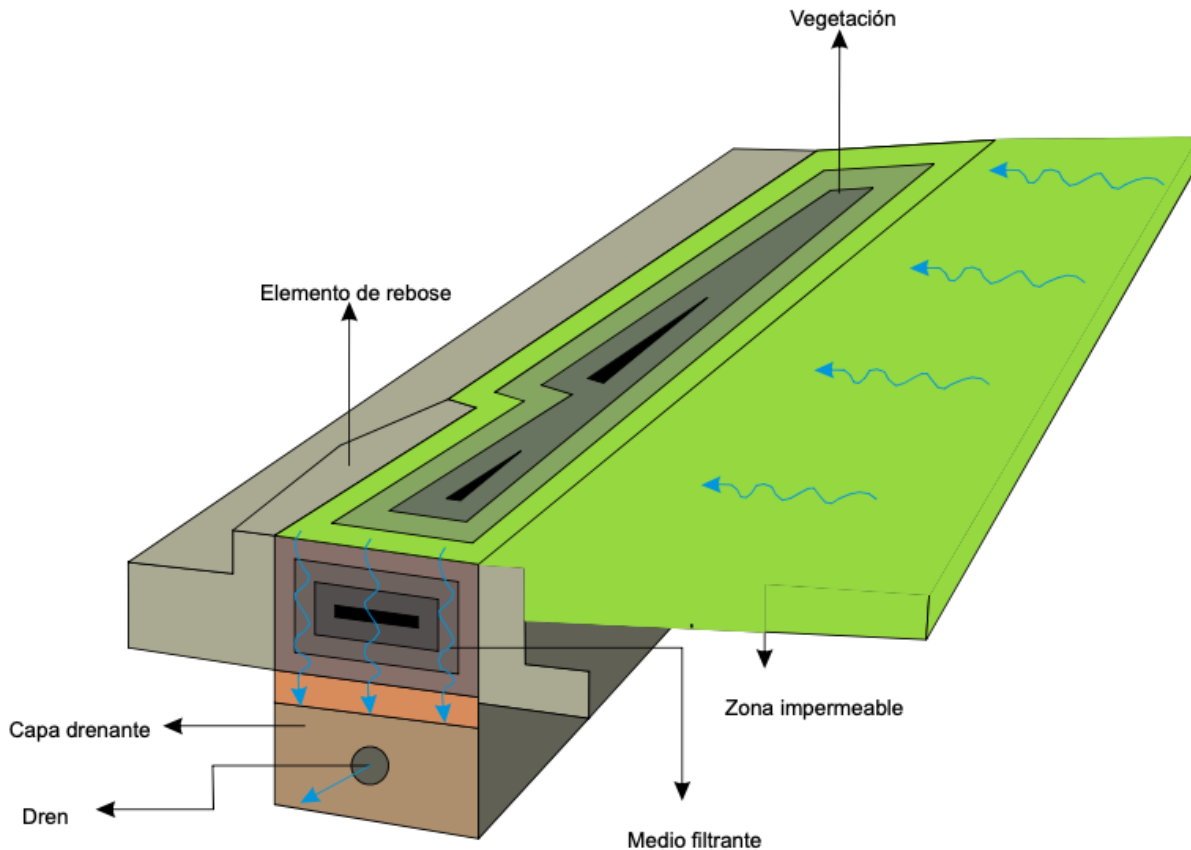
29. Vista 3D del alcantarillado para áreas verdes.
